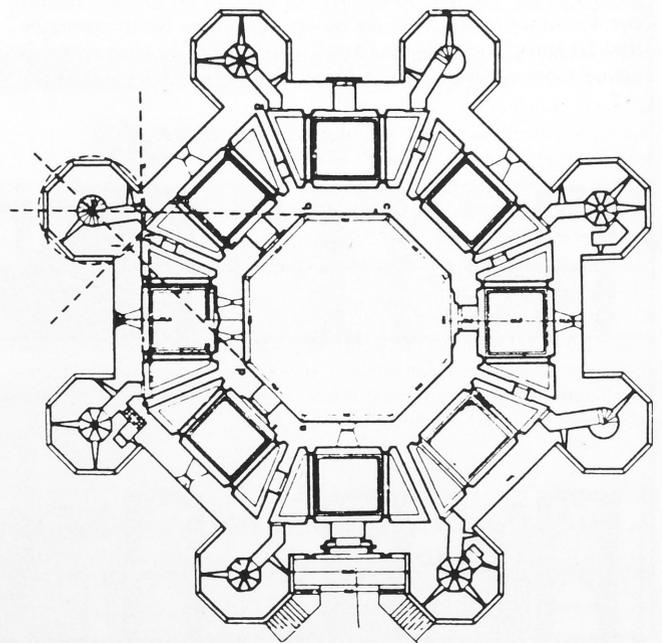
Castel del Monte, Grundriß mit Eintragung der Konstruktion der Türme und des Außenachtecks nach A. Tavolaro (*Castellum 18*, 1973, Abb. 9).
